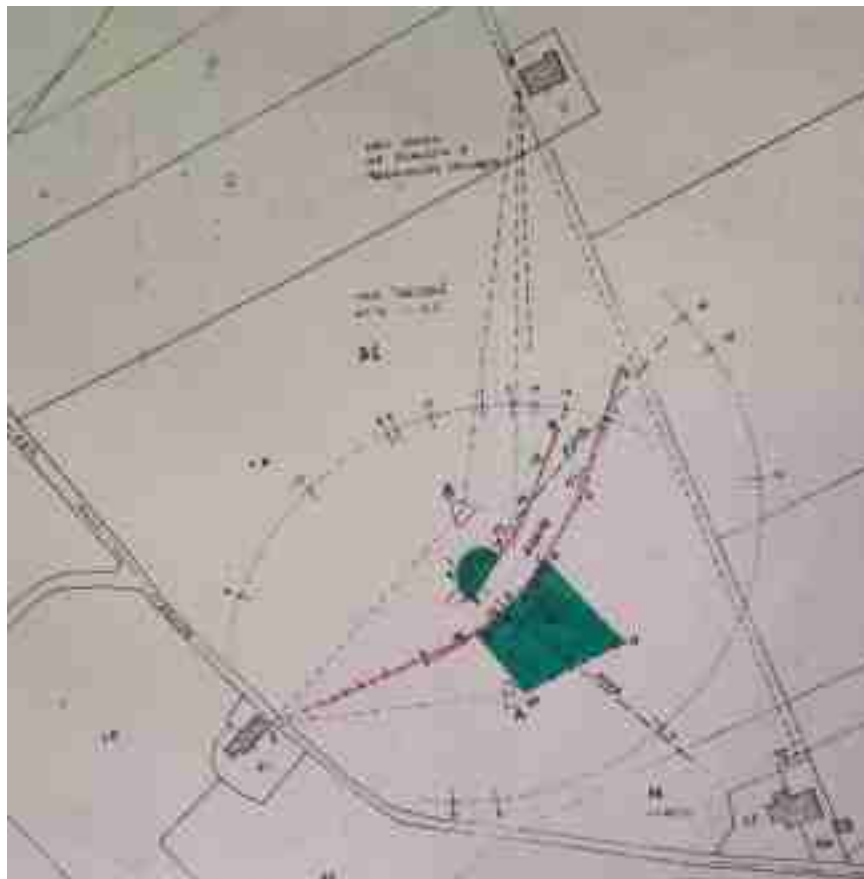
Planimetria della zona di scavo estratta dalla documentazione originale
